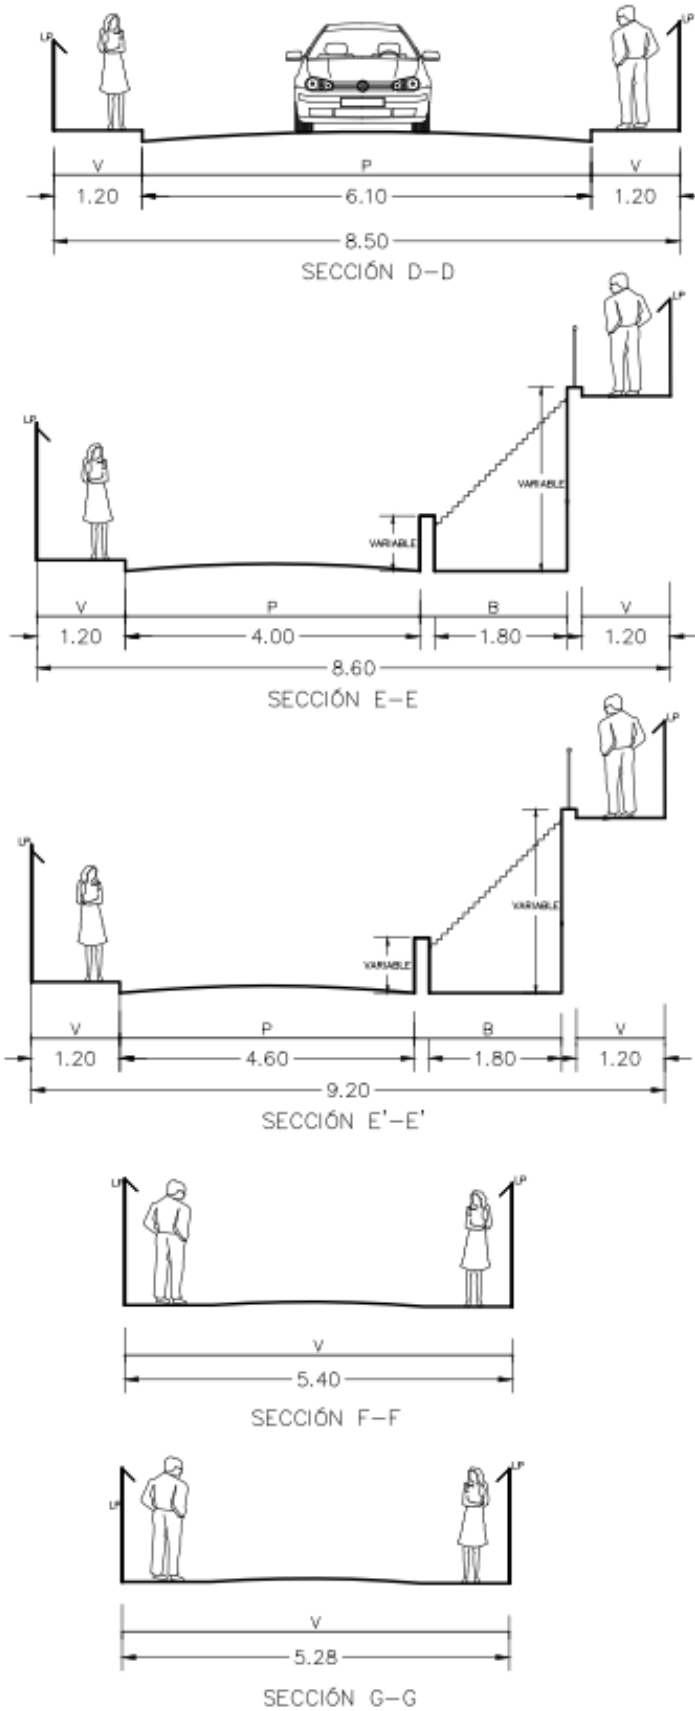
SECCIONES VIALES PLAN ESPECIFICO
